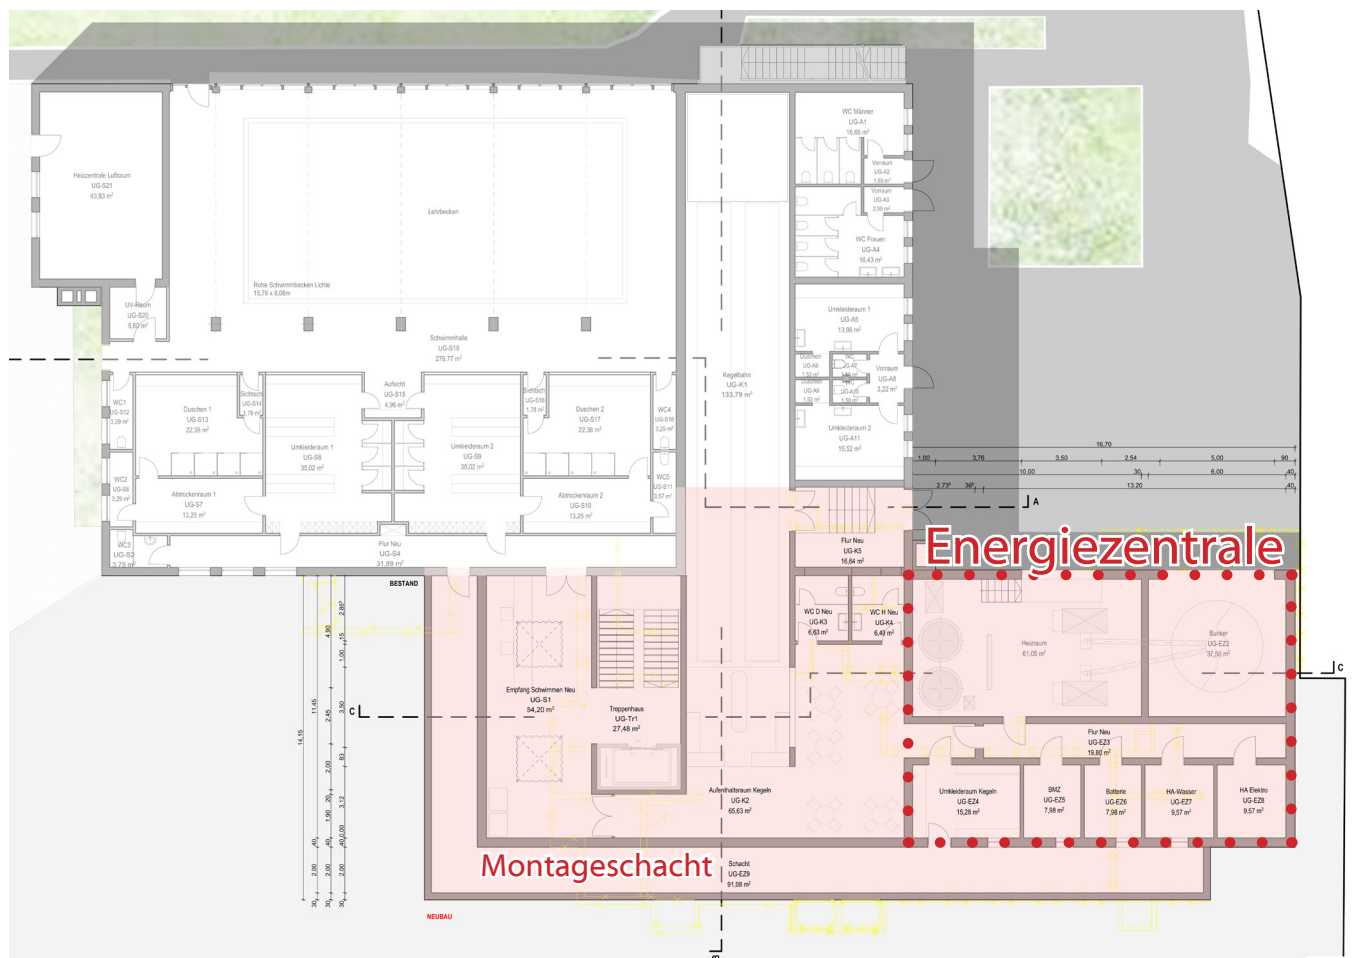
Grundriss Untergeschoss - Neubau Foyerbereich mit Energiezentrale
